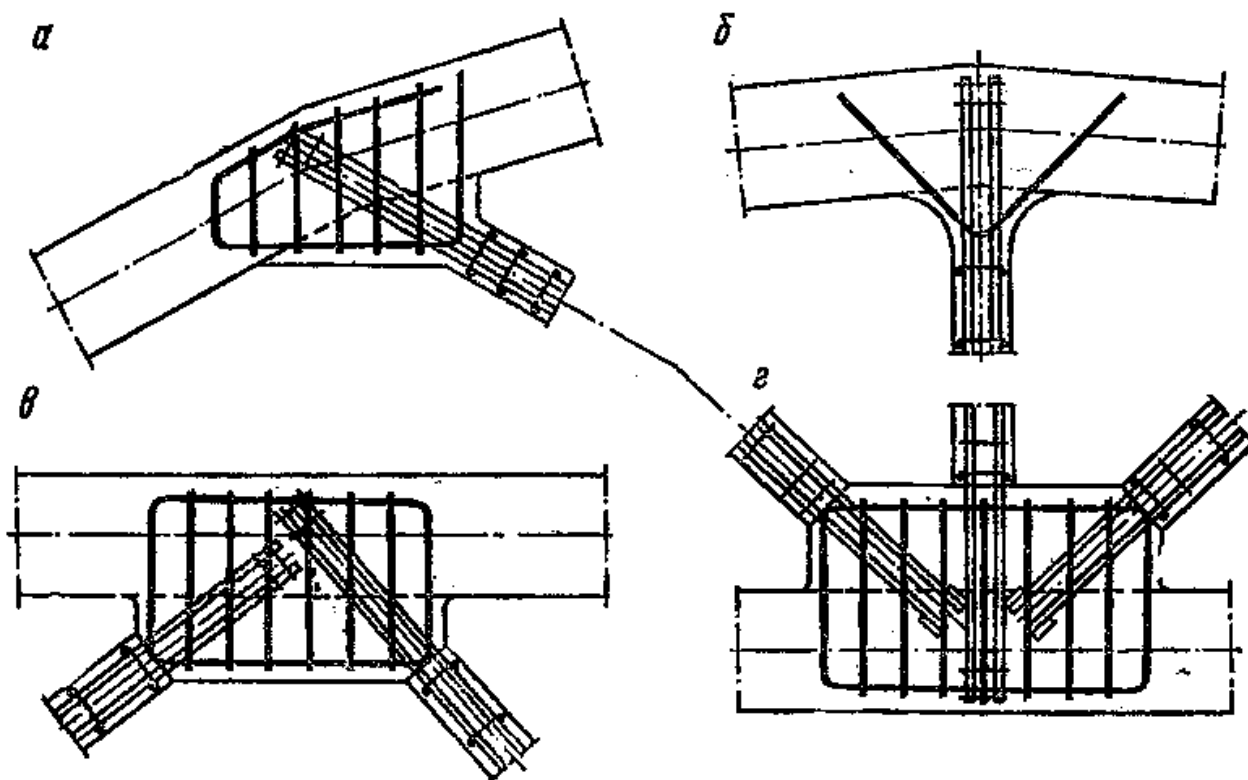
Армирование узлов ферм: а...в - верхнего пояса; г - нижнего пояса
